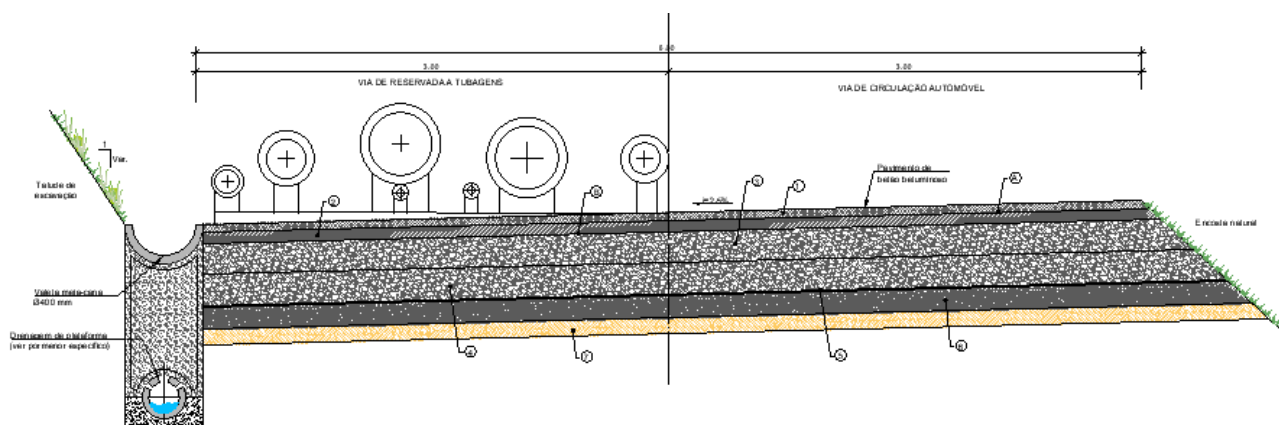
Perfil transversal tipo – Plataforma 6,0 m
